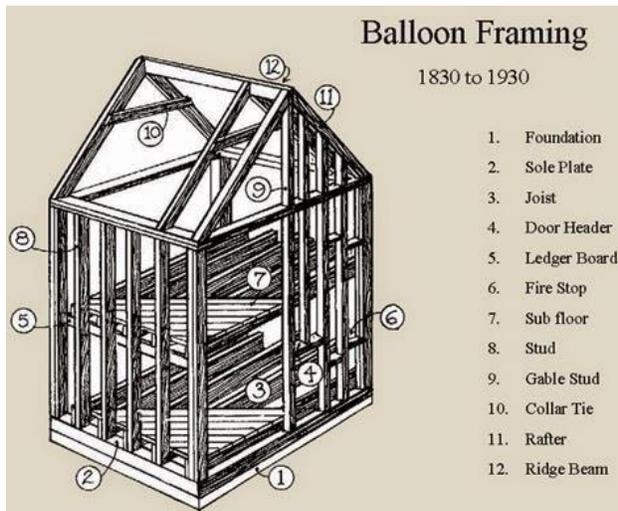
Sistema constructivo ballon frame. Fuente: www.maderayconstruccion.com.arg
